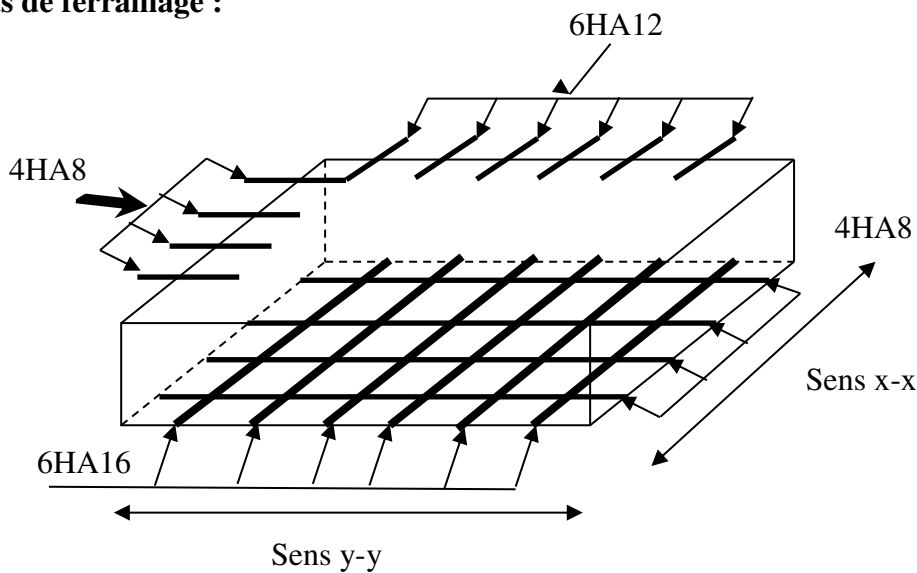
Schéma de ferrailage d'une dalle sur 3 appuis.
